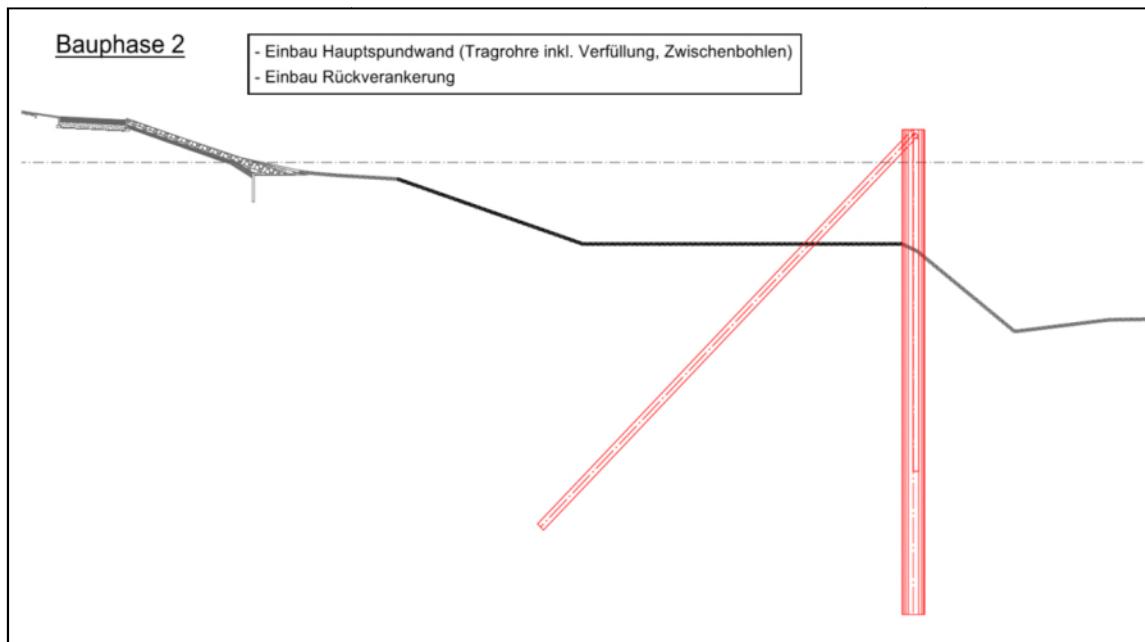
Einbau der Hauptspundwand und der Rückverankerungen (Auszug Plan GP-500)
